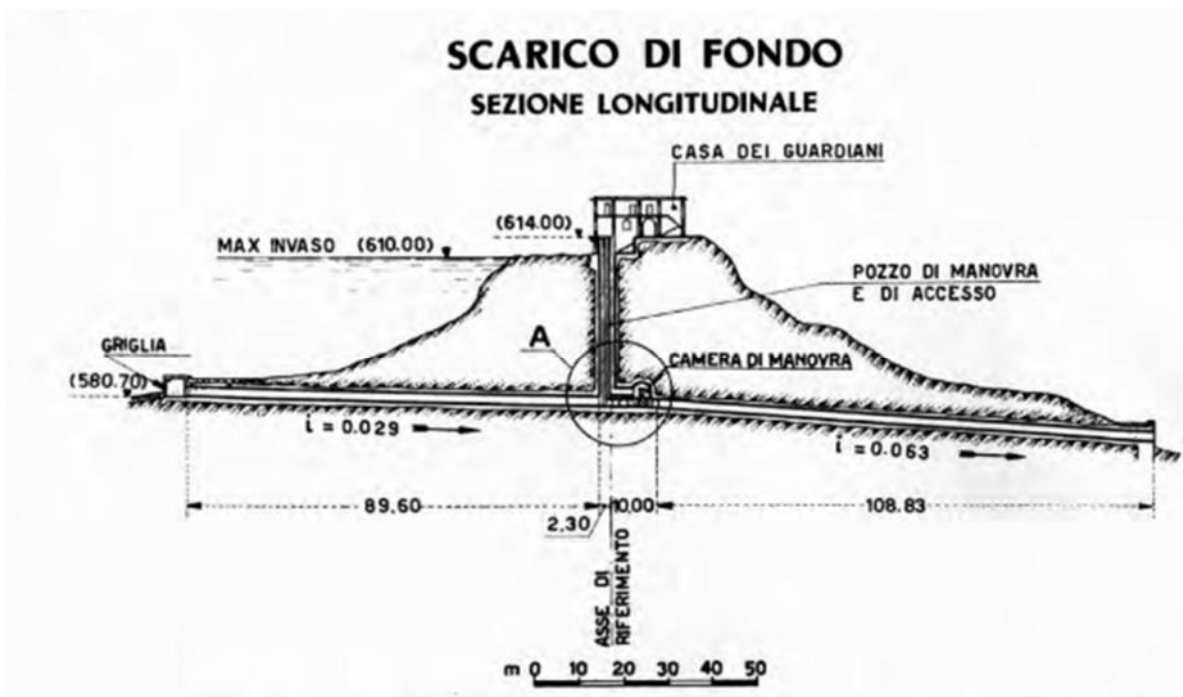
Sezione longitudinale dello scarico di fondo della diga di Piana degli Albanesi (ENEL, 2013)
